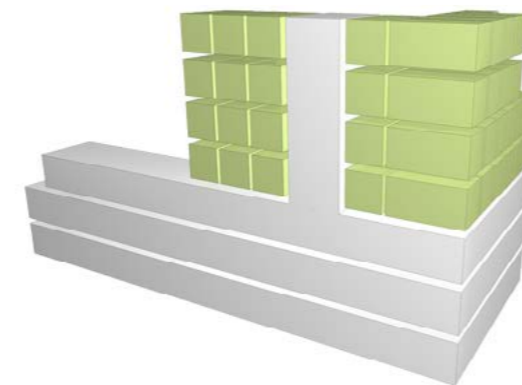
Suddivisione dell'edificio secondo la tipologia strutturale.
